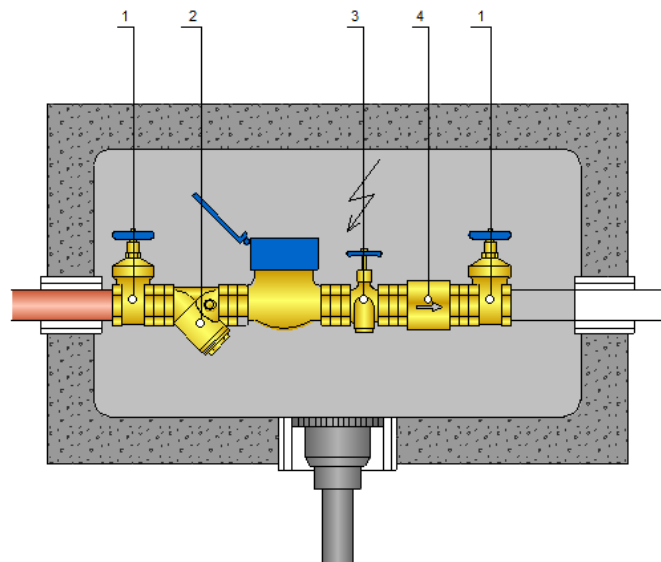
Detalle constructivo de la acometida (tramo 14-13)
